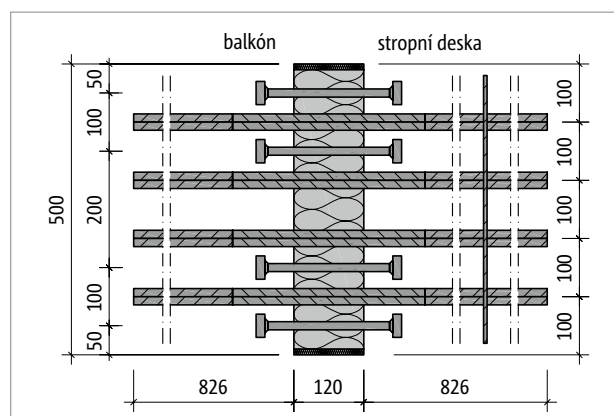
Schöck Isokorb® XT typ QP-V1: Půdorys prvku
